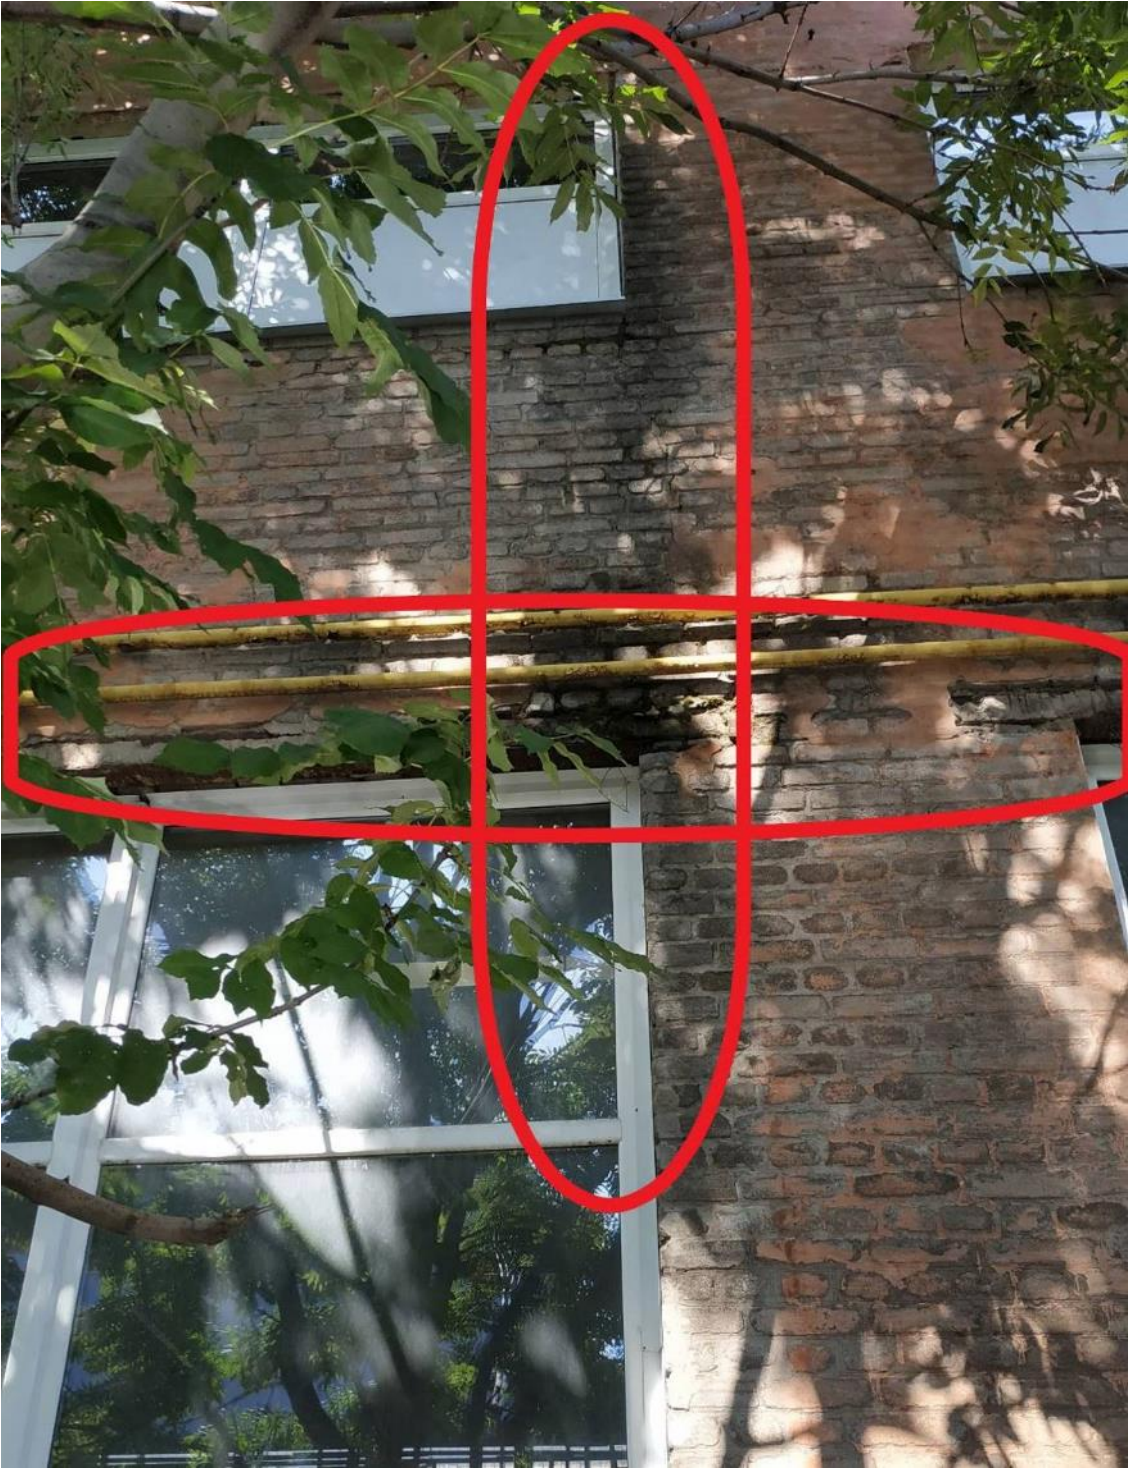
Сліди замочування цегляної кладки, відшарування захисного шару бетону (Фасад 1-17)
